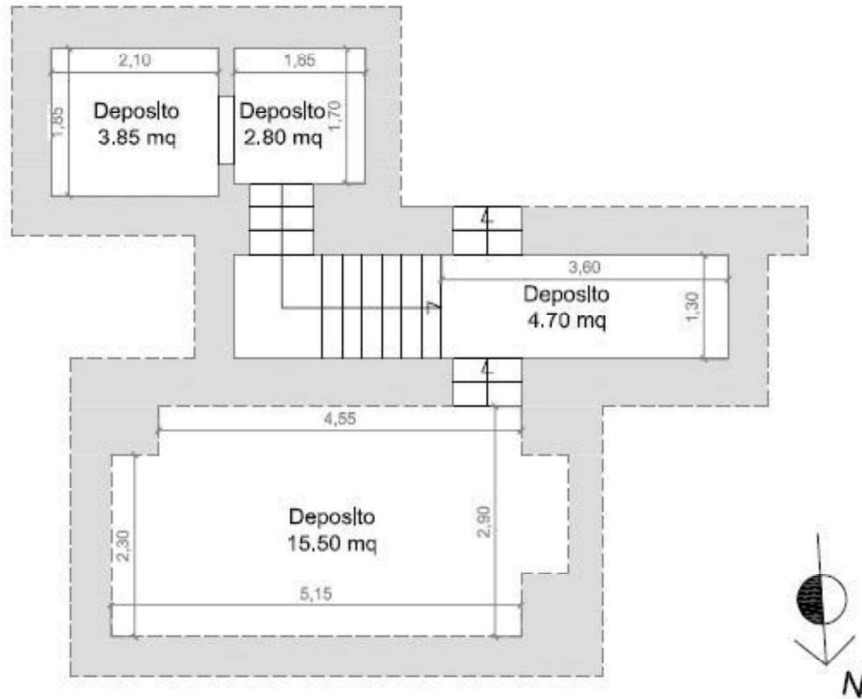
Planimetria Stato di Fatto Immobile, Piano Seminterrato, Foglio 35, p.lla 817, Sub //.
